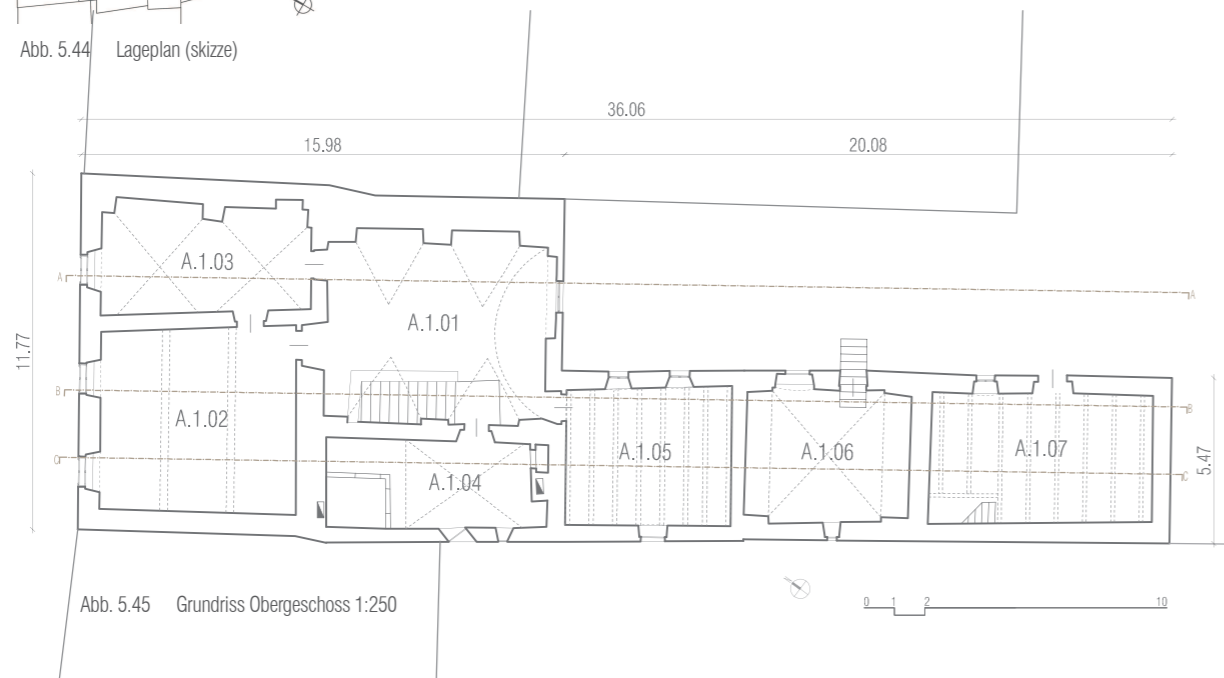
Grundriss Obergeschoss 1:250
